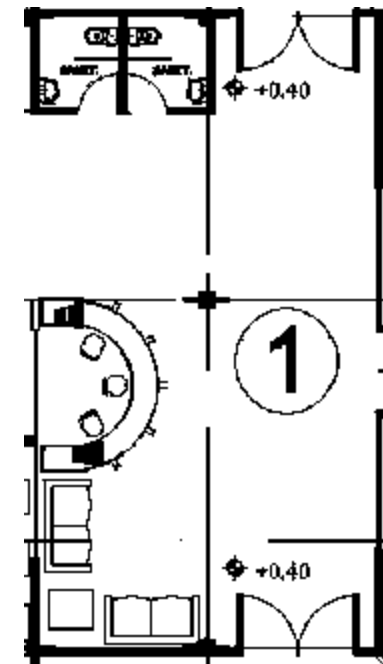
area de estudio. Fuente: Plano arquitectónico del proyecto
